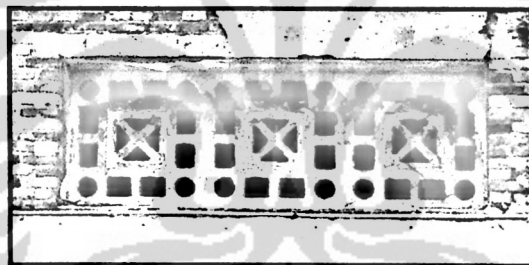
Konstruksi balok latei pada lubang angin persegi panjang
